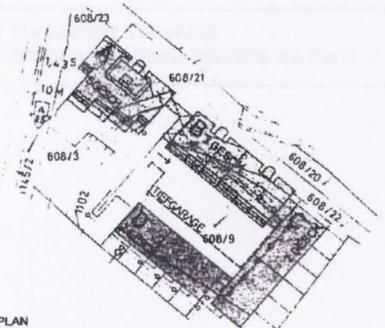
Grundriss Blöcke Hans-Riehlgasse 1974
